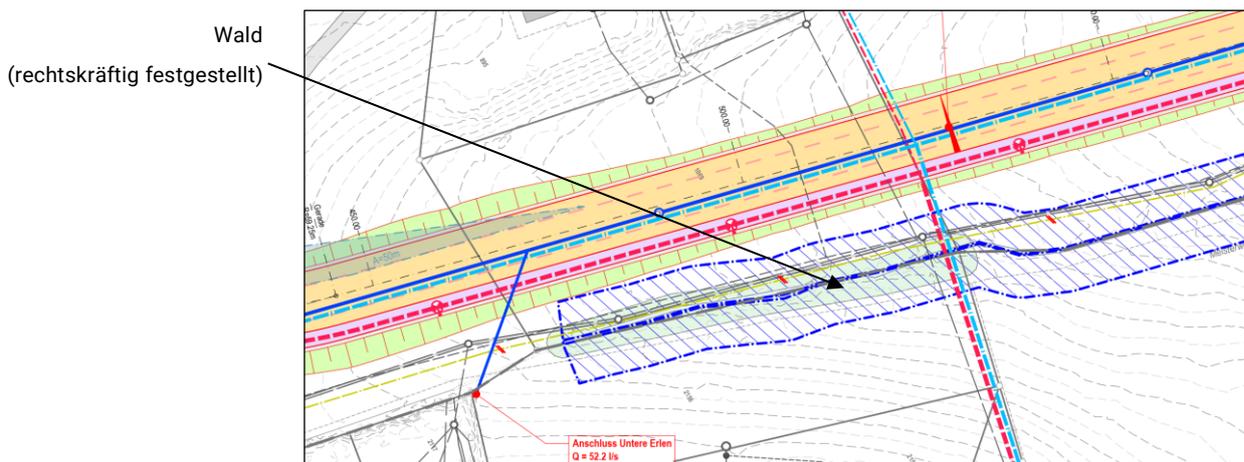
Ausschnitt Strassenprojekt, Quelle: Studie Junkerstrasse, Geoinfra Ingenieure AG, rev. dat. 09.08.2024
